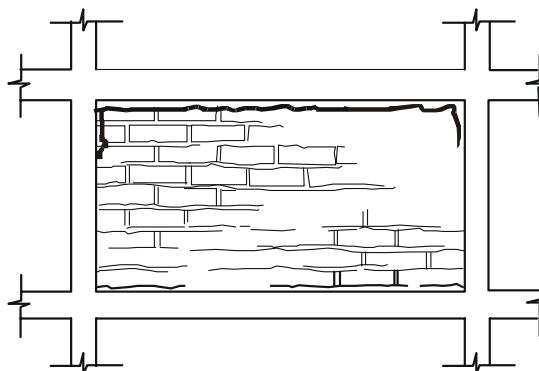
fissuras de destacamento entre a parede e a estrutura reticulada de concreto armado por retração da alvenaria (THOMAZ, 1989)
